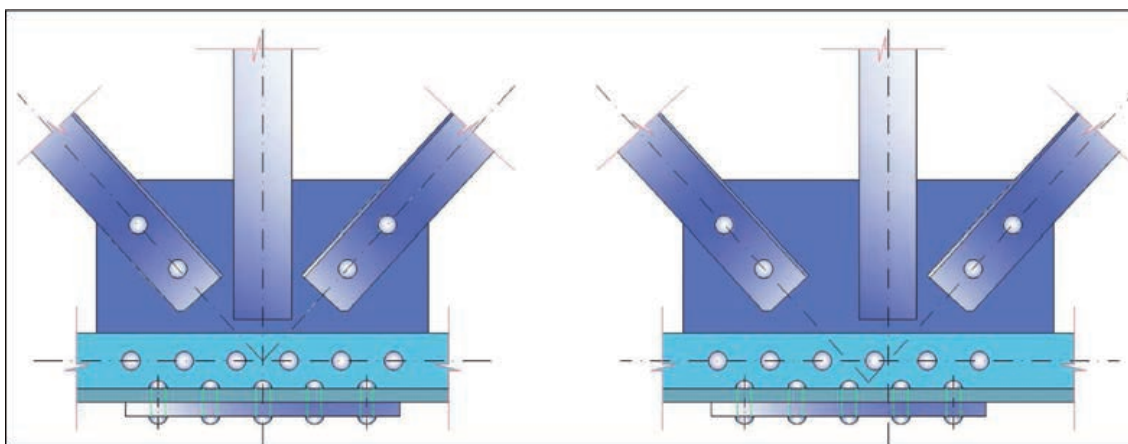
CONEXIÓN SIN EXCENRICIDAD (IZQUIERDA) Y CON EXCENRICIDAD (DERECHA).
